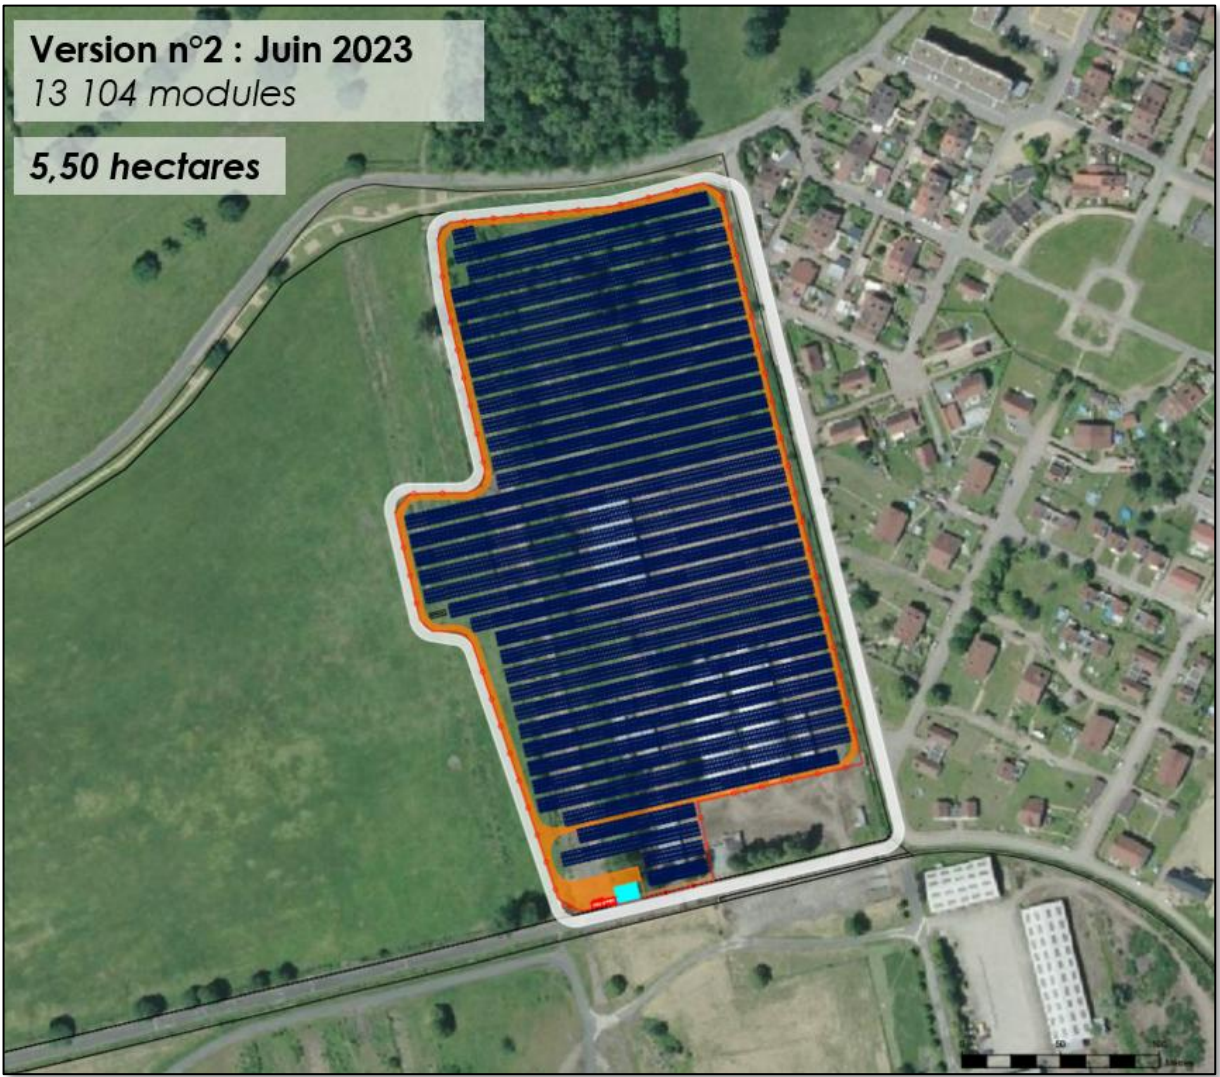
Plan masse de la variante 2 de l'implantation (Source : ELEMENTS).
